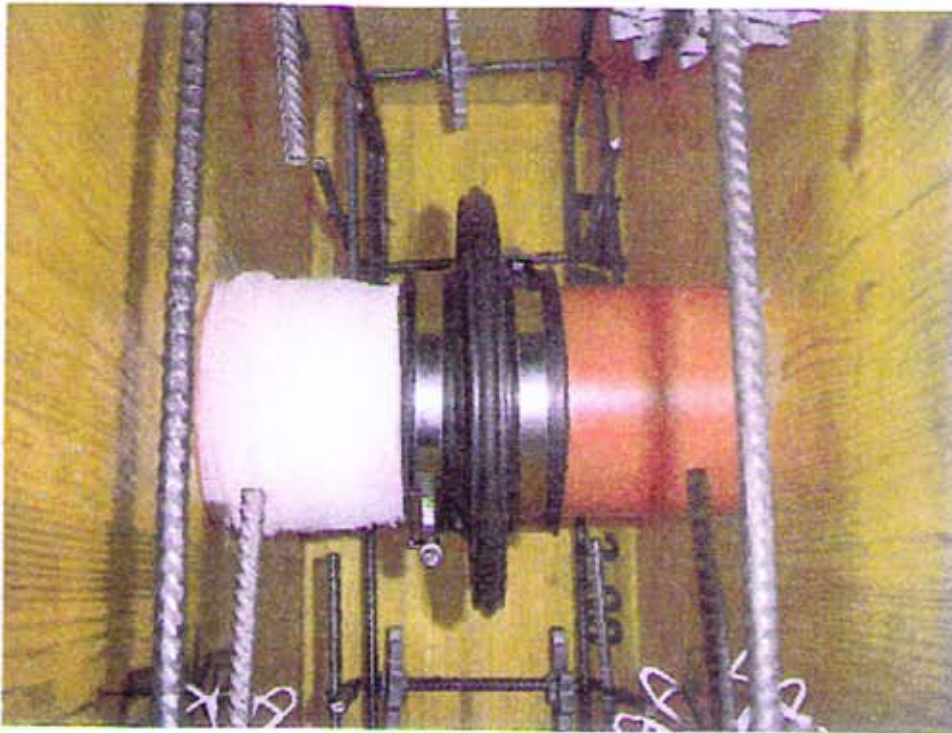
Prüfkörper vor dem Betonieren, links: wasserdurchlässige Umhüllung zur Nachbildung eines Schwindspaltes
